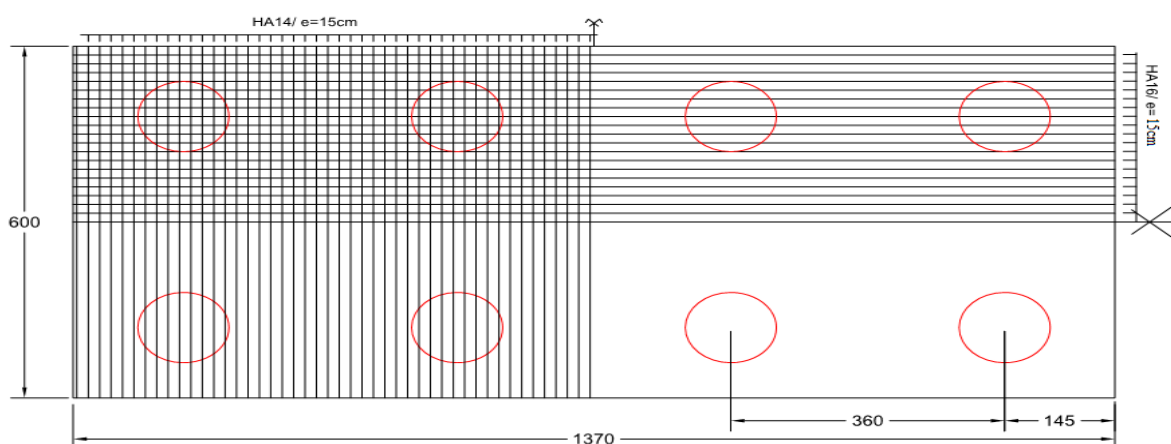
Plan de ferrailage de la nappe supérieure
